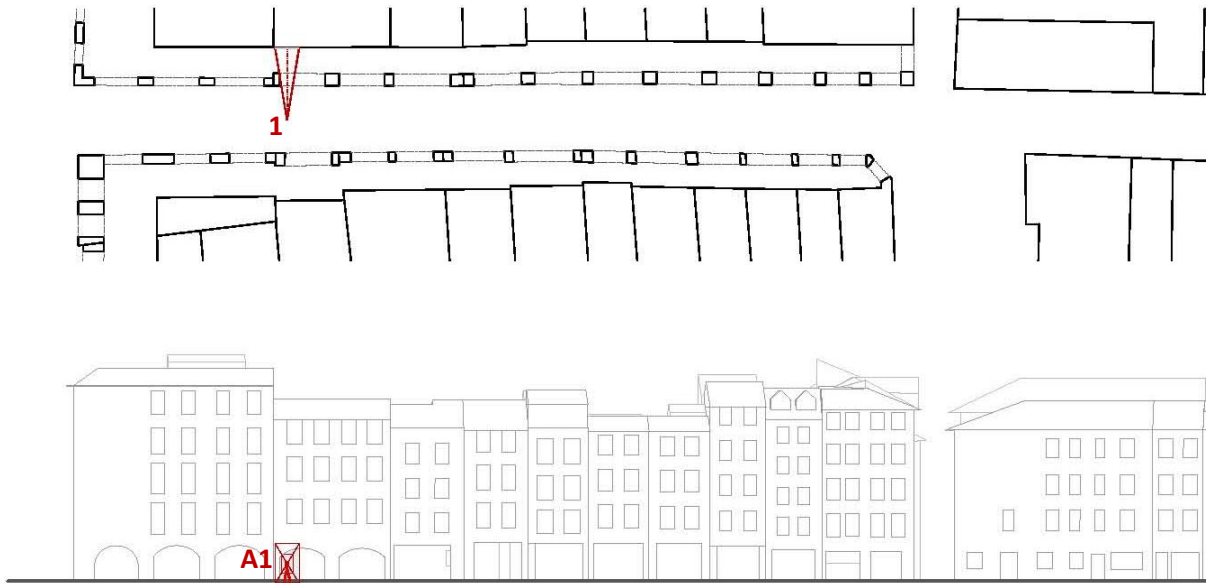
14. Esquema en planta y alzado del área abarcada en una termografía en la dirección normal a la fachada realizada desde la posición 1 en la Rue des Tonneliers de Bayona
